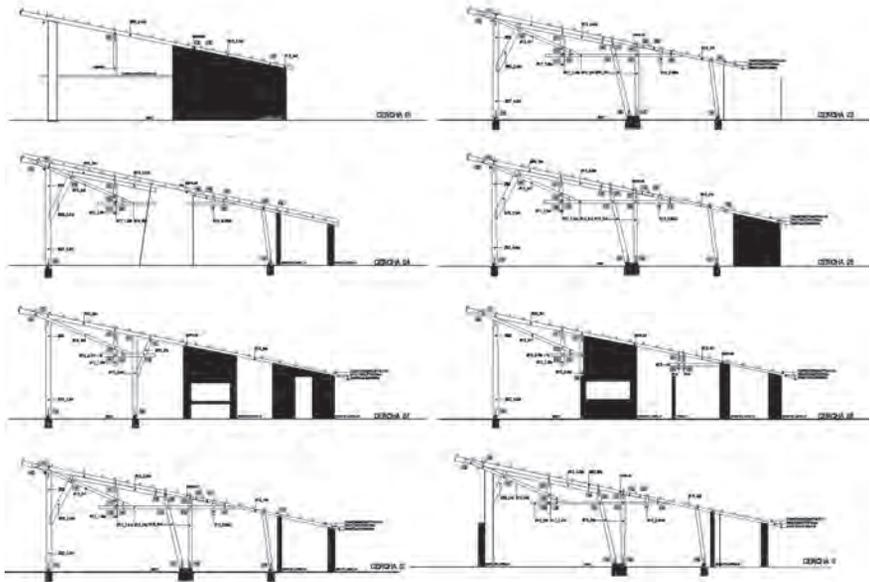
Dibujo lineal. Elaboración propia. Variantes de pórtico construido en 1947, reconstruido en 2009
